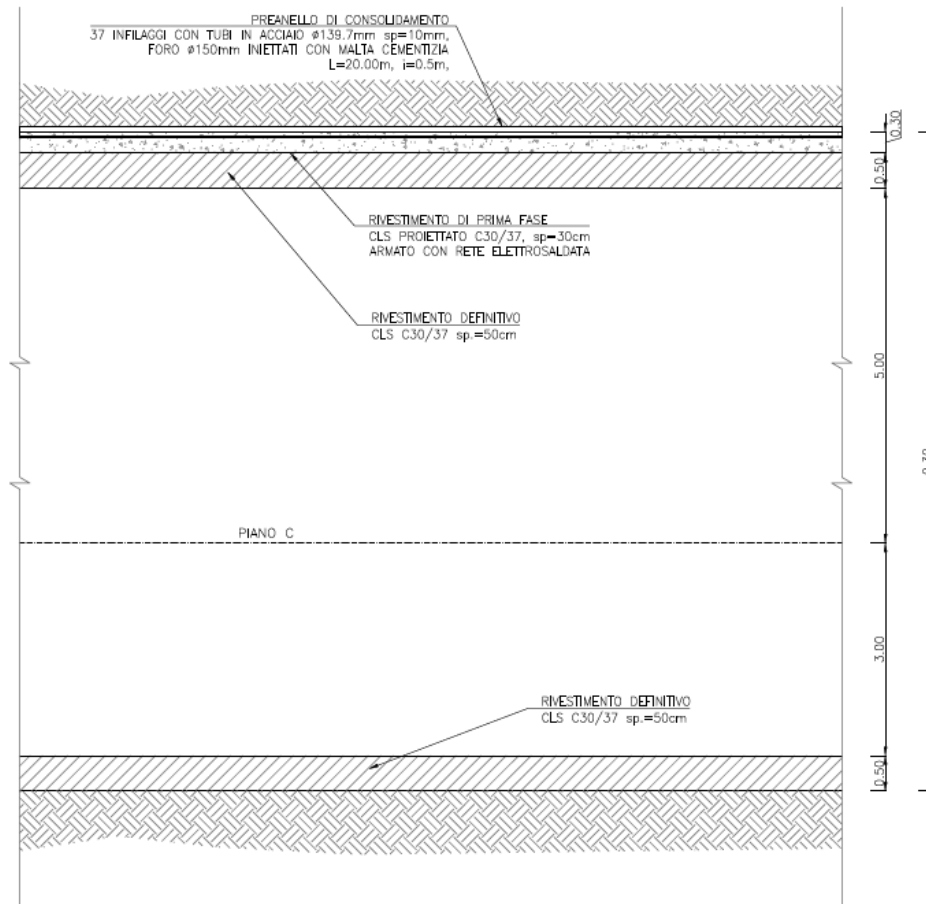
Sezione tipo DImb: geometria del cavo e interventi di sostegno, sezione longitudinale
